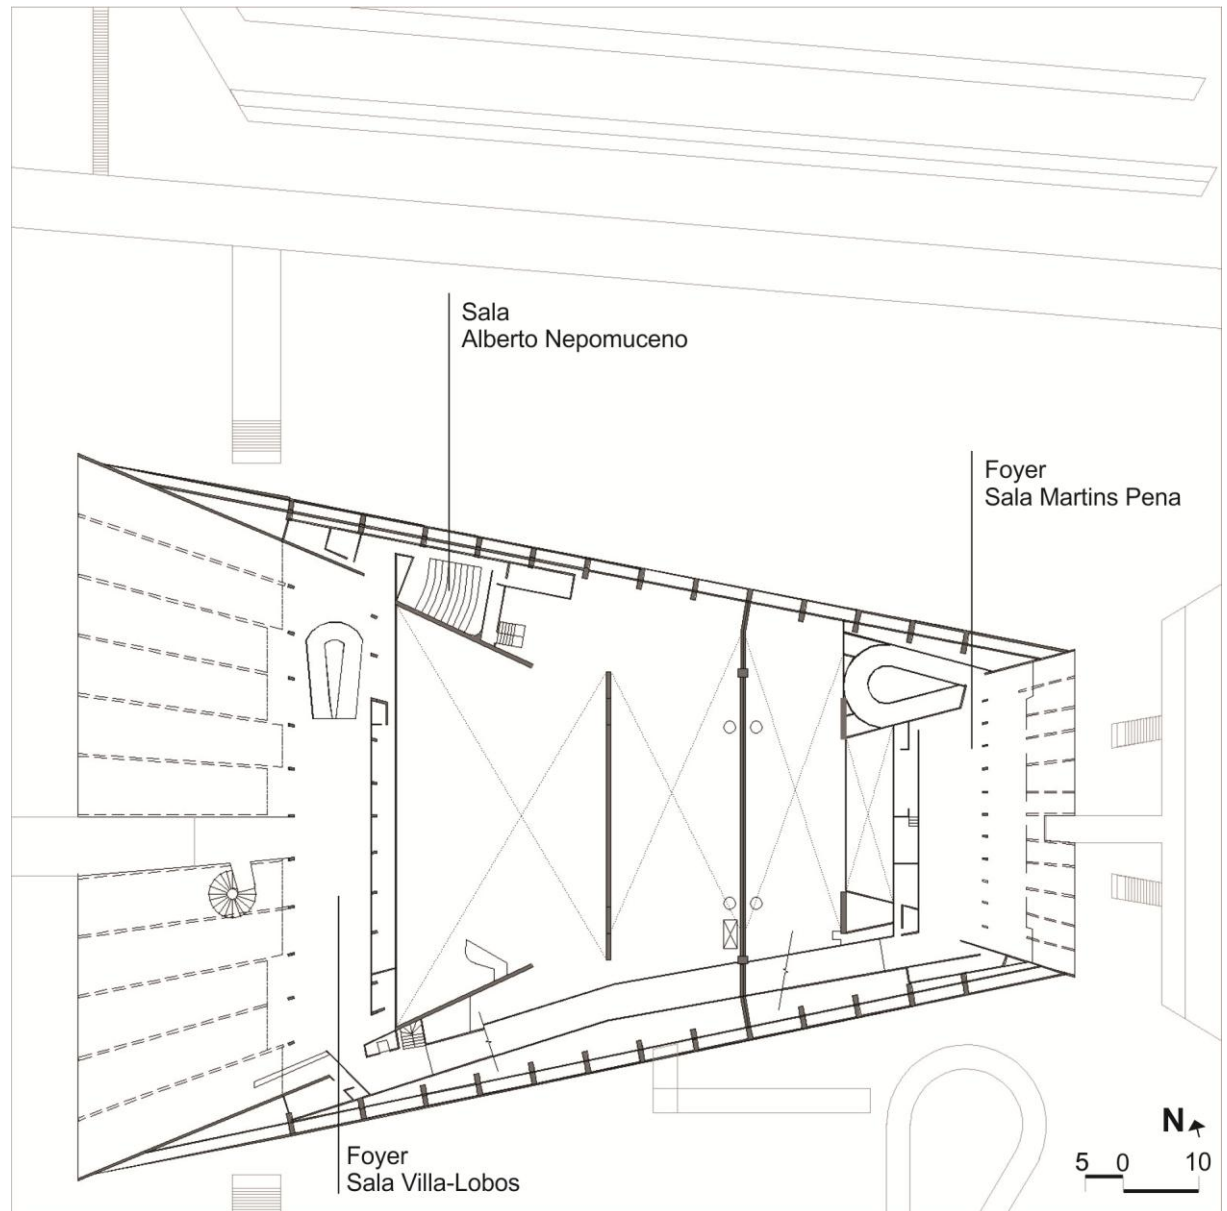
Planta Baixa - Pavimento Térreo (+0,05 m).
